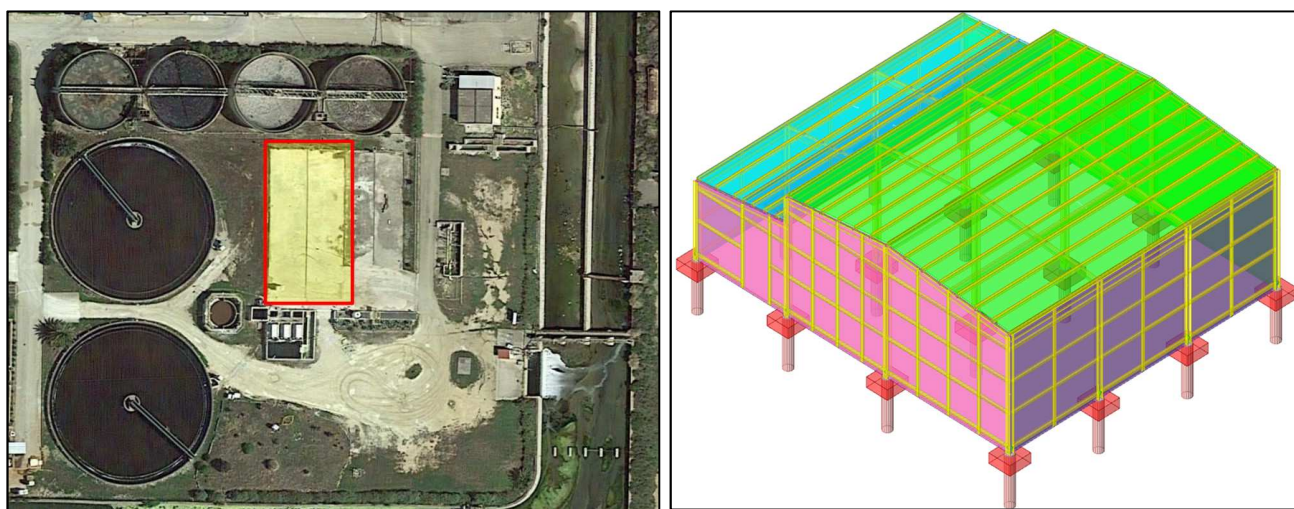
Vista in pianta della platea esistente all'interno dell'impianto (sx) e Modello tridimensionale della struttura (dx)
